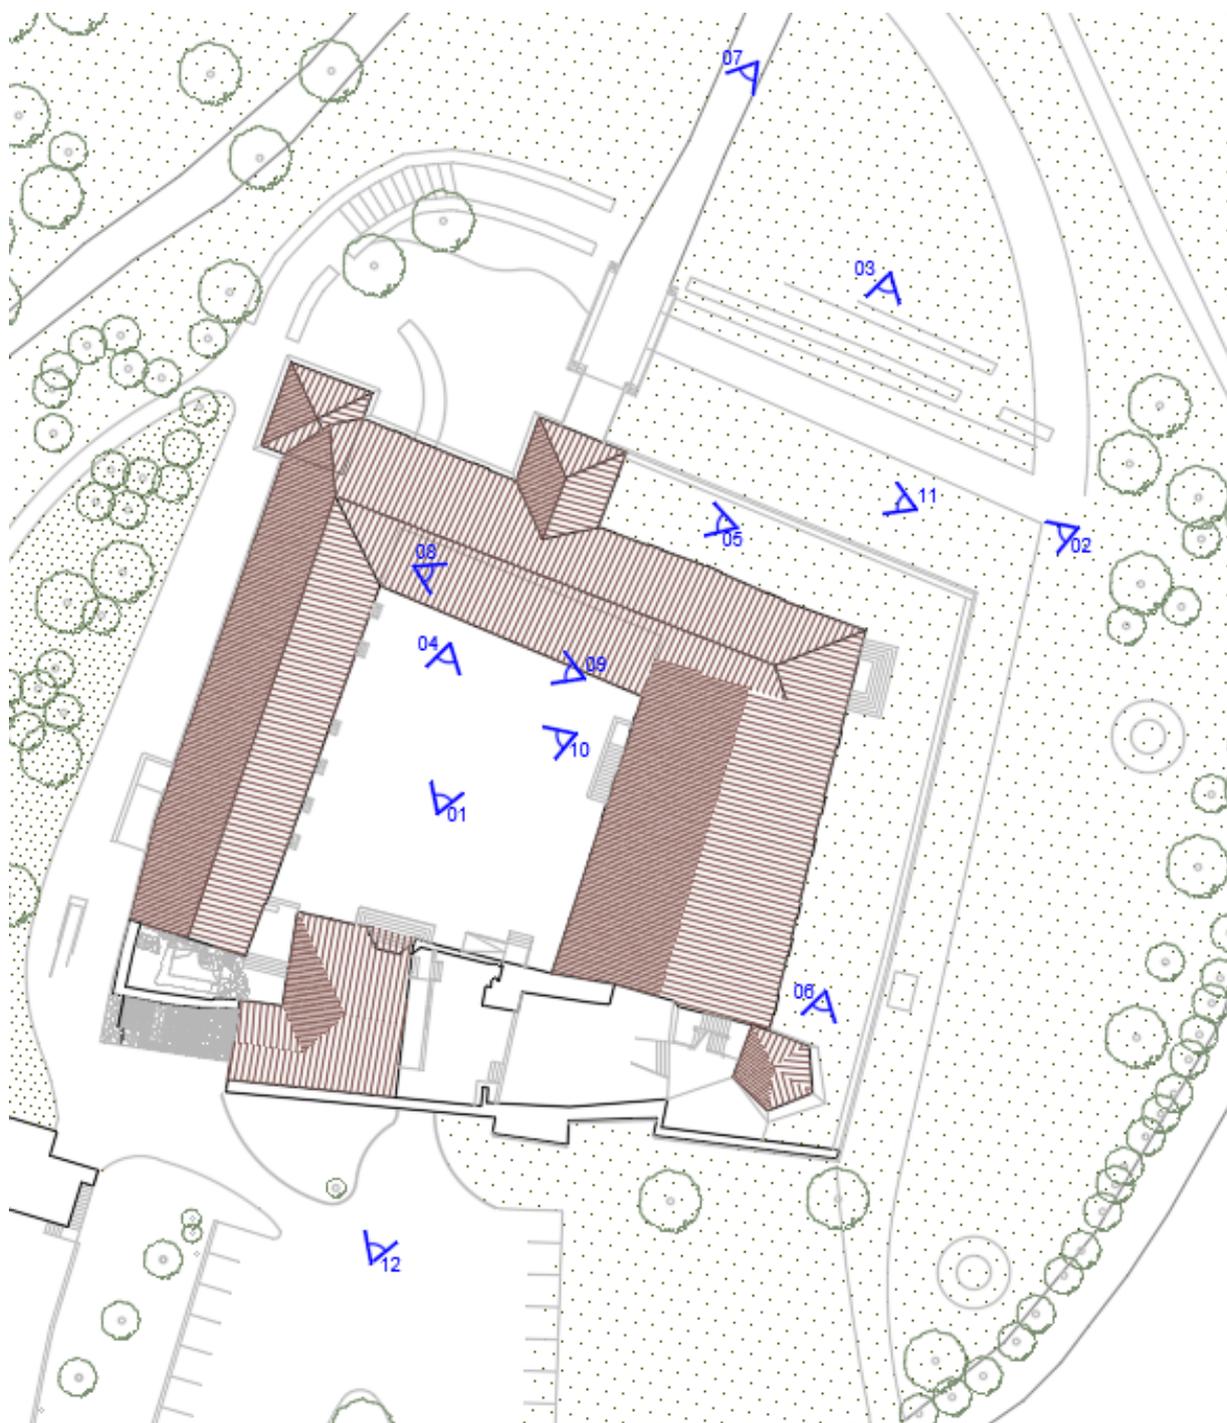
Planimetria con indicazione punti di presa delle fotografie
